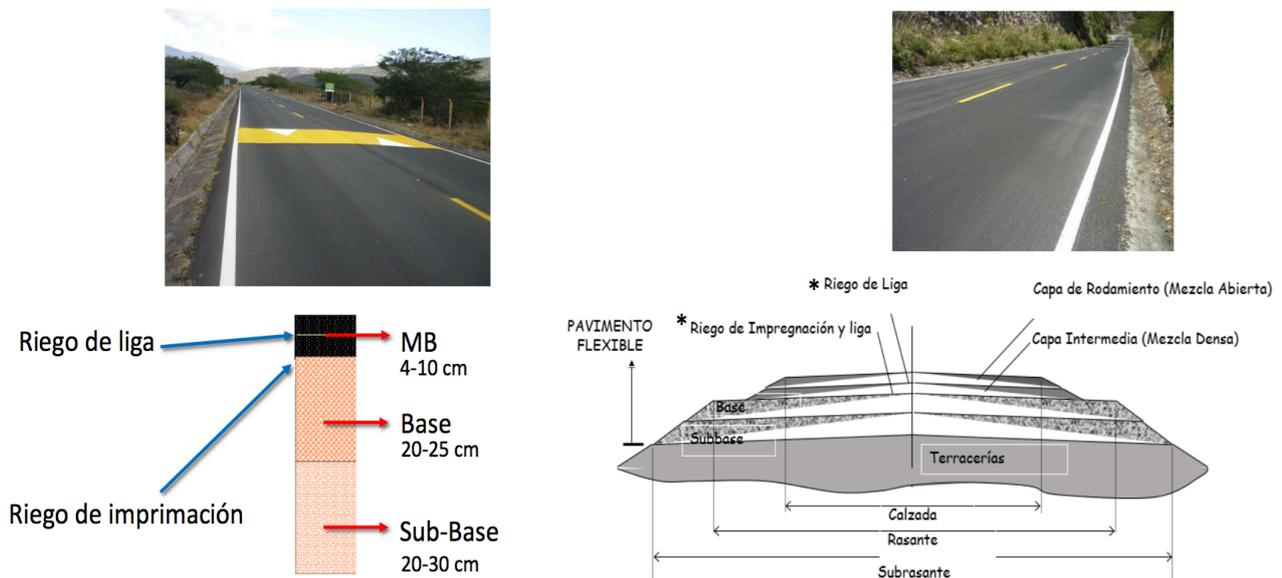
Pavimento flexible. Fuente: Clase de diseño de pavimentos por Gustavo Boada(2017).
